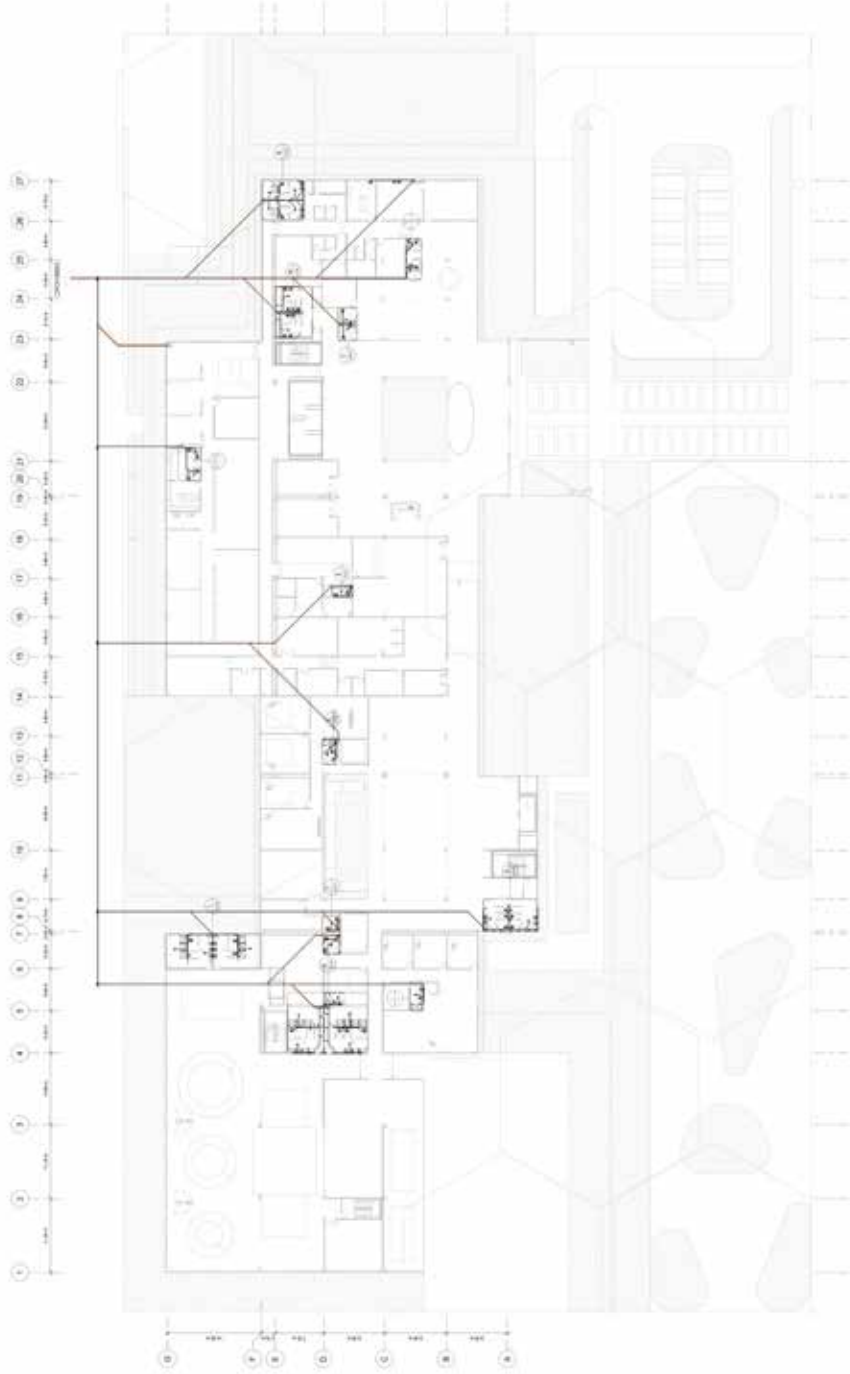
PLANTA BAJA - IS Agua Servida
